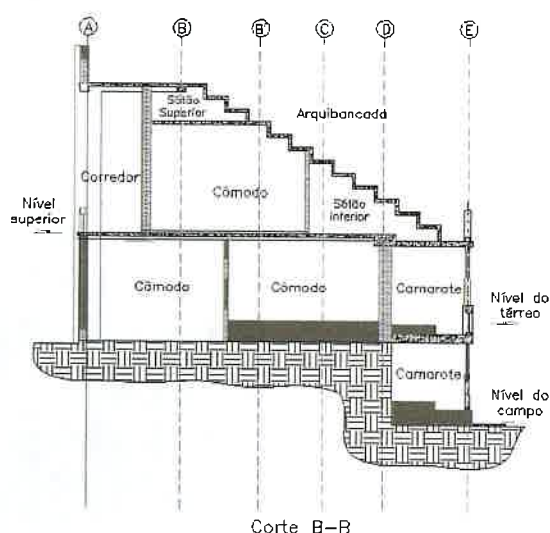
Corte transversal da Edificação 2 – Geometria entre os eixos 8 a 17.
